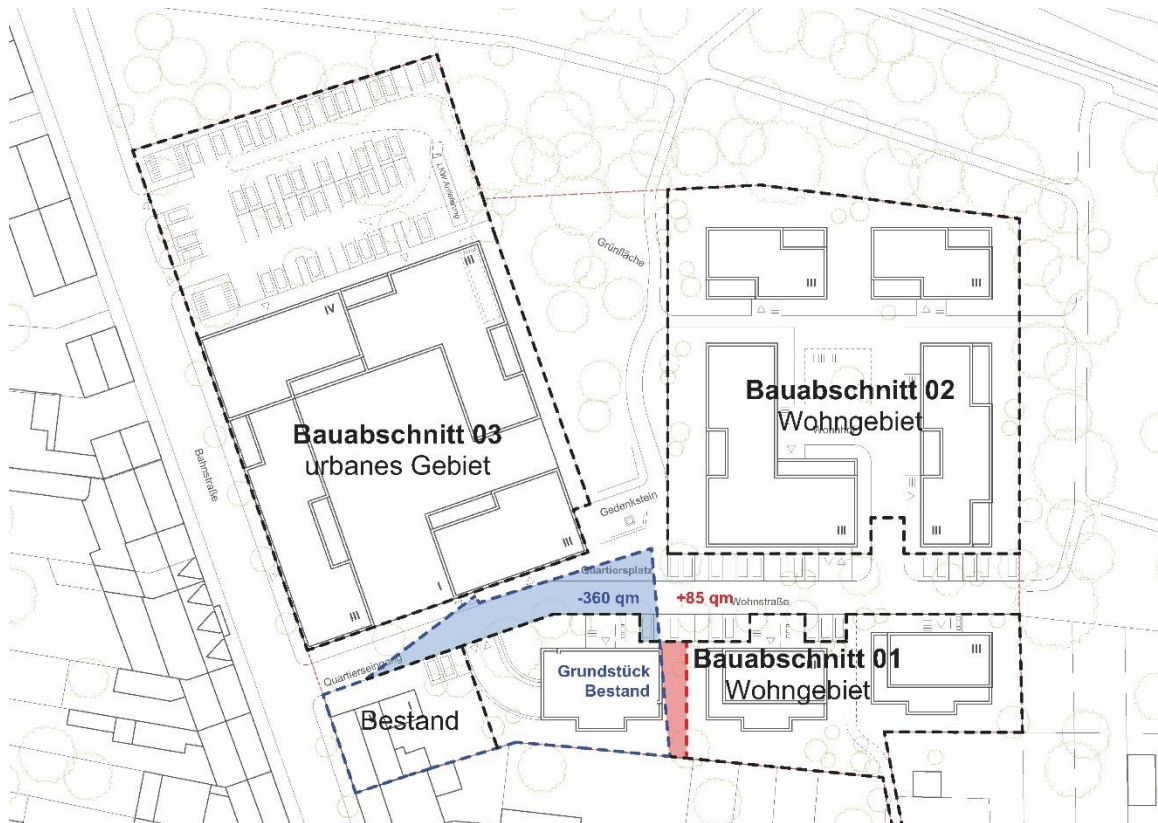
Rahmenplanung | Grundstückszuschnitte © LECKE ARCHITEKTEN)
